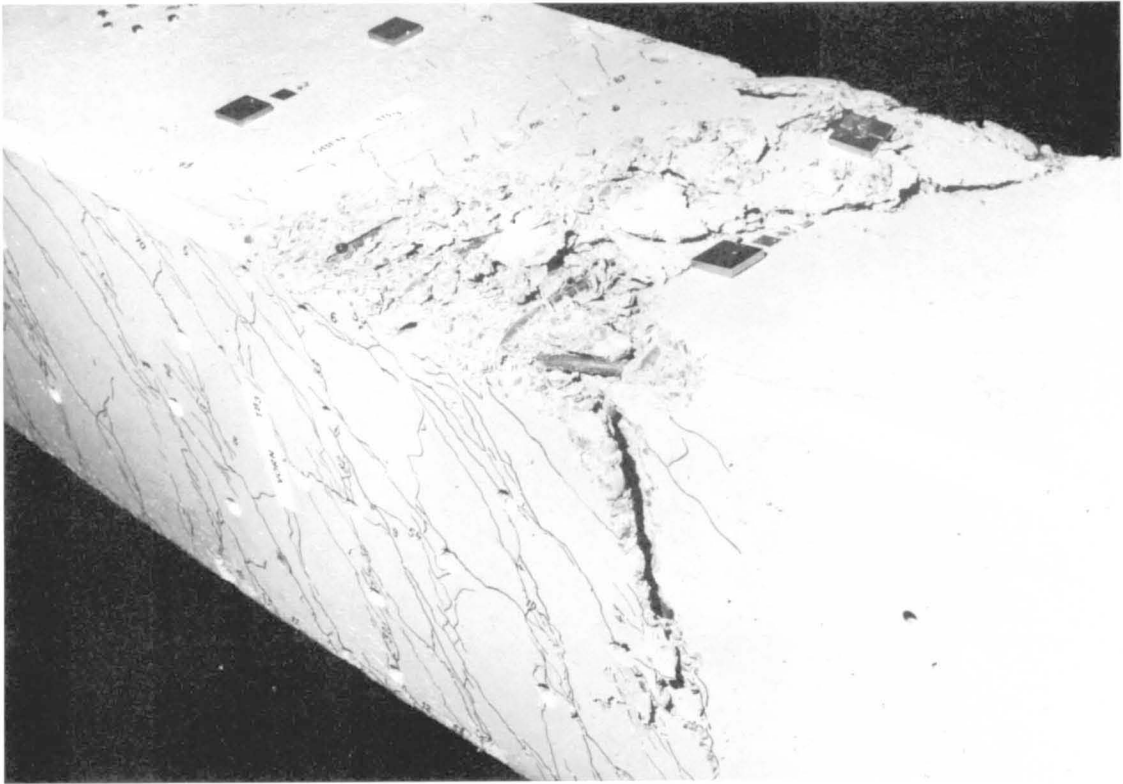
(a): Bruchbereich Balken TB₃ (oben, vorn)
